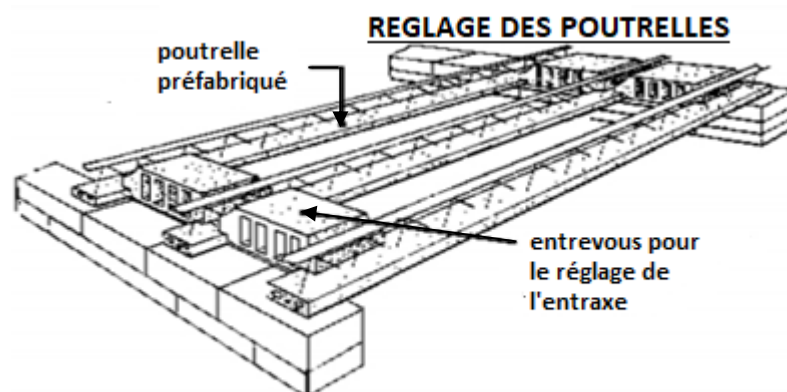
Mise en œuvre des planchers avec poutrelles préfabriquées
